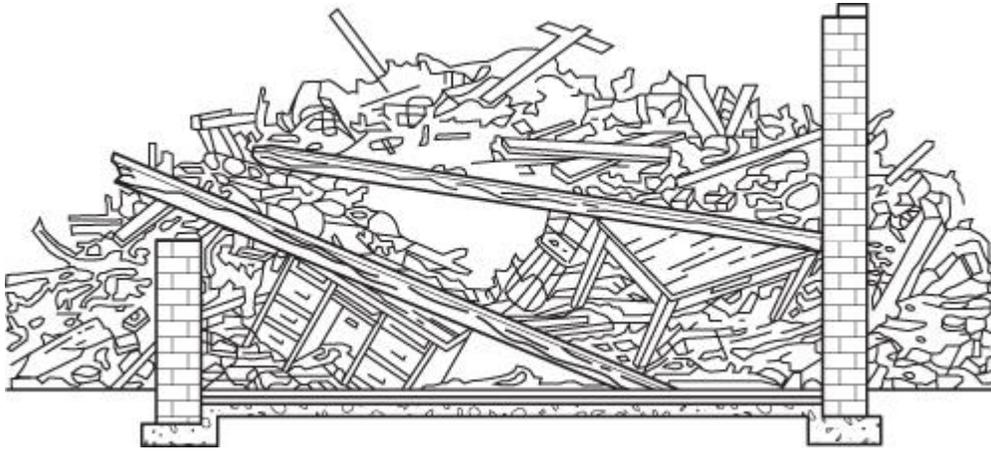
(d) Cantilever Floor Collapse. [Cortesía de la Agencia de Preparación para la Defensa Civil (Departamento de Defensa de Estados Unidos)]
